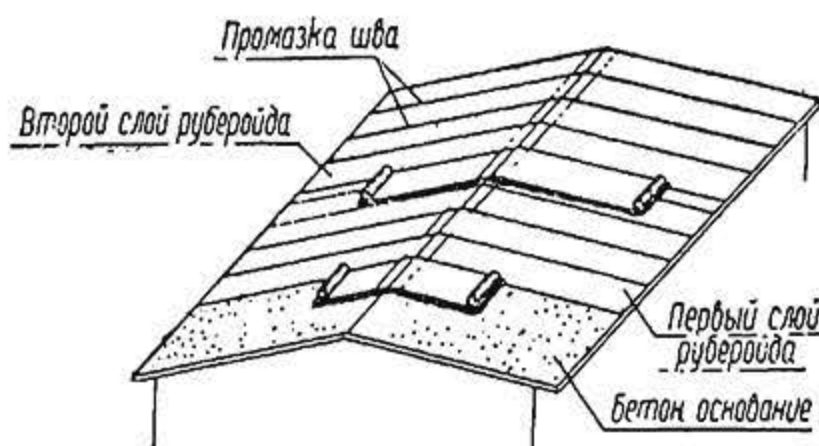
Двухслойное руберойдное покрытие по бетонному основанию, при наличии термоизоляционного слоя.
